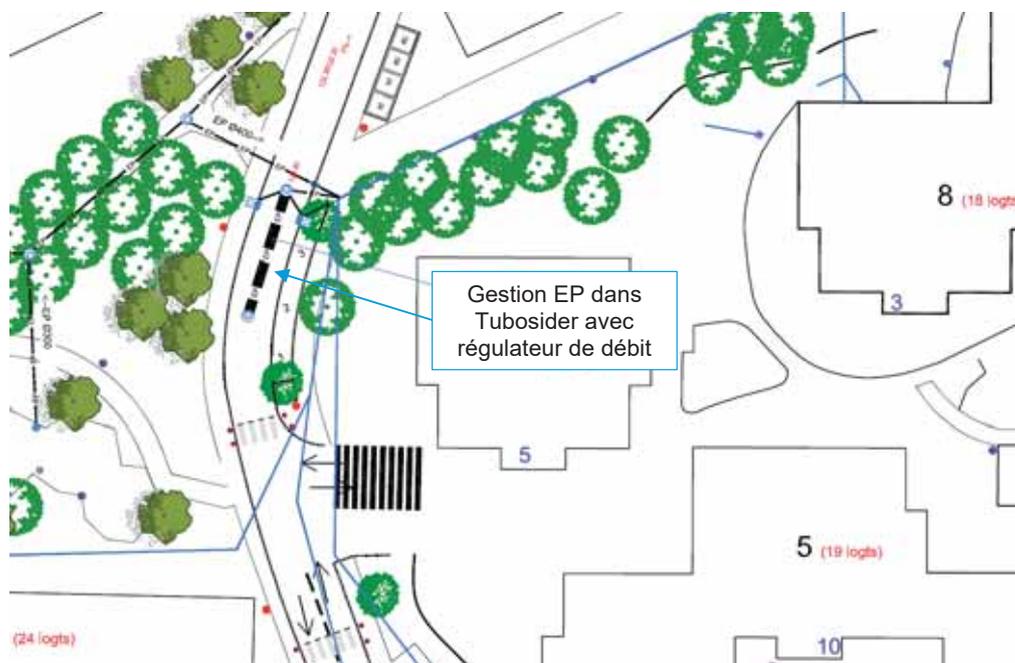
Extrait du plan d'assainissement représentant la structure de stockage des eaux pluviales pour l'espace public Geldrop
